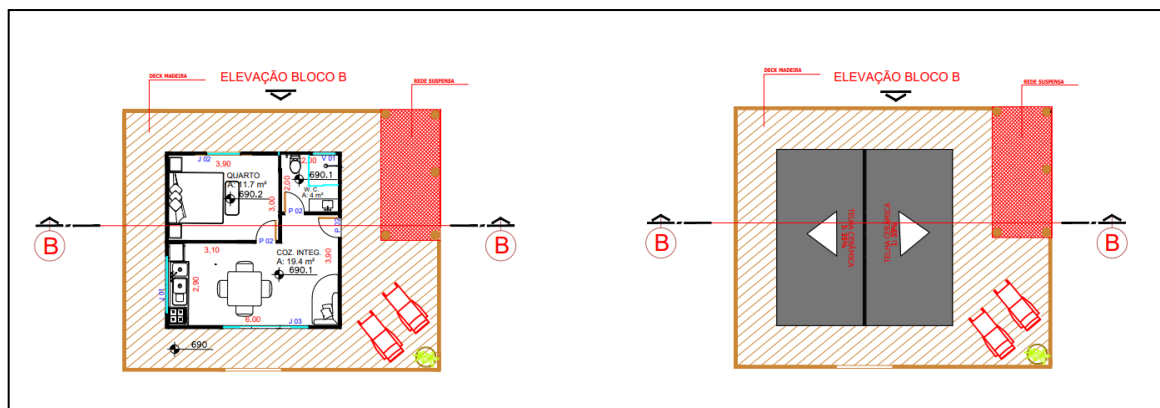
Planta baixa e planta de cobertura da tipologia *Dollhouse
